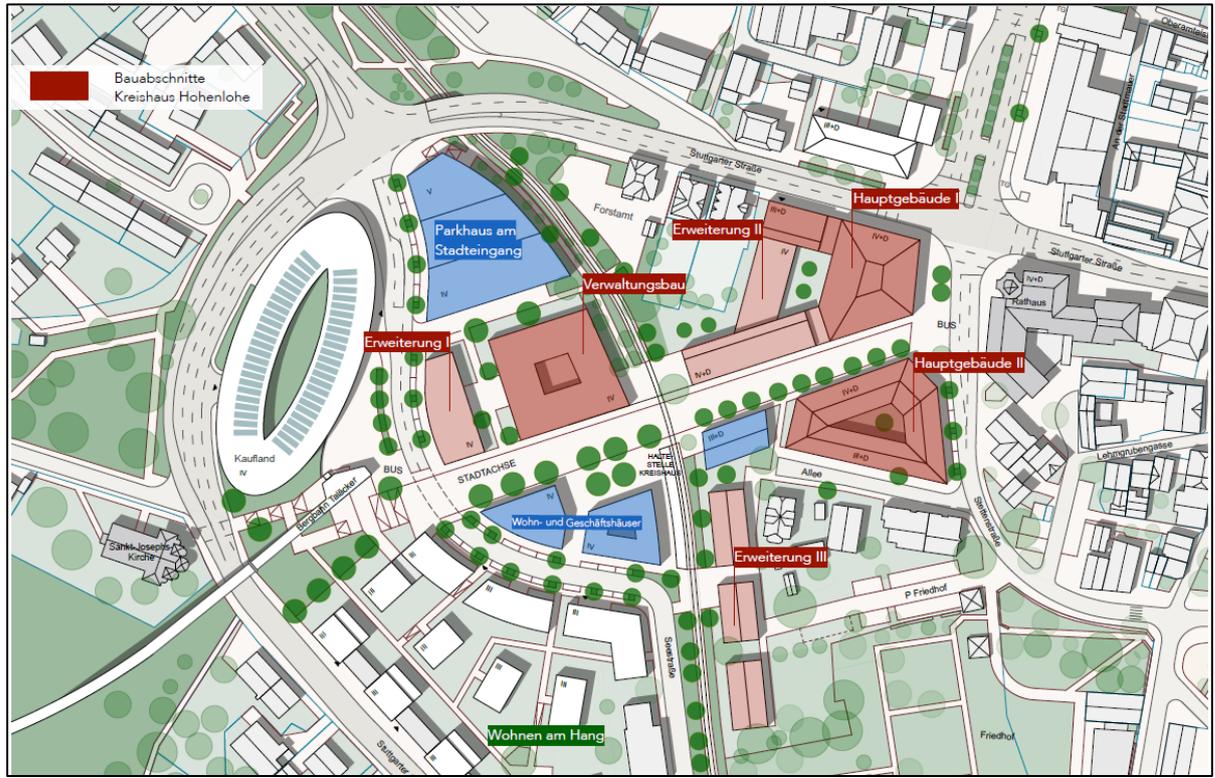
Rahmenplan Stadteingang Stuttgarter Straße.
